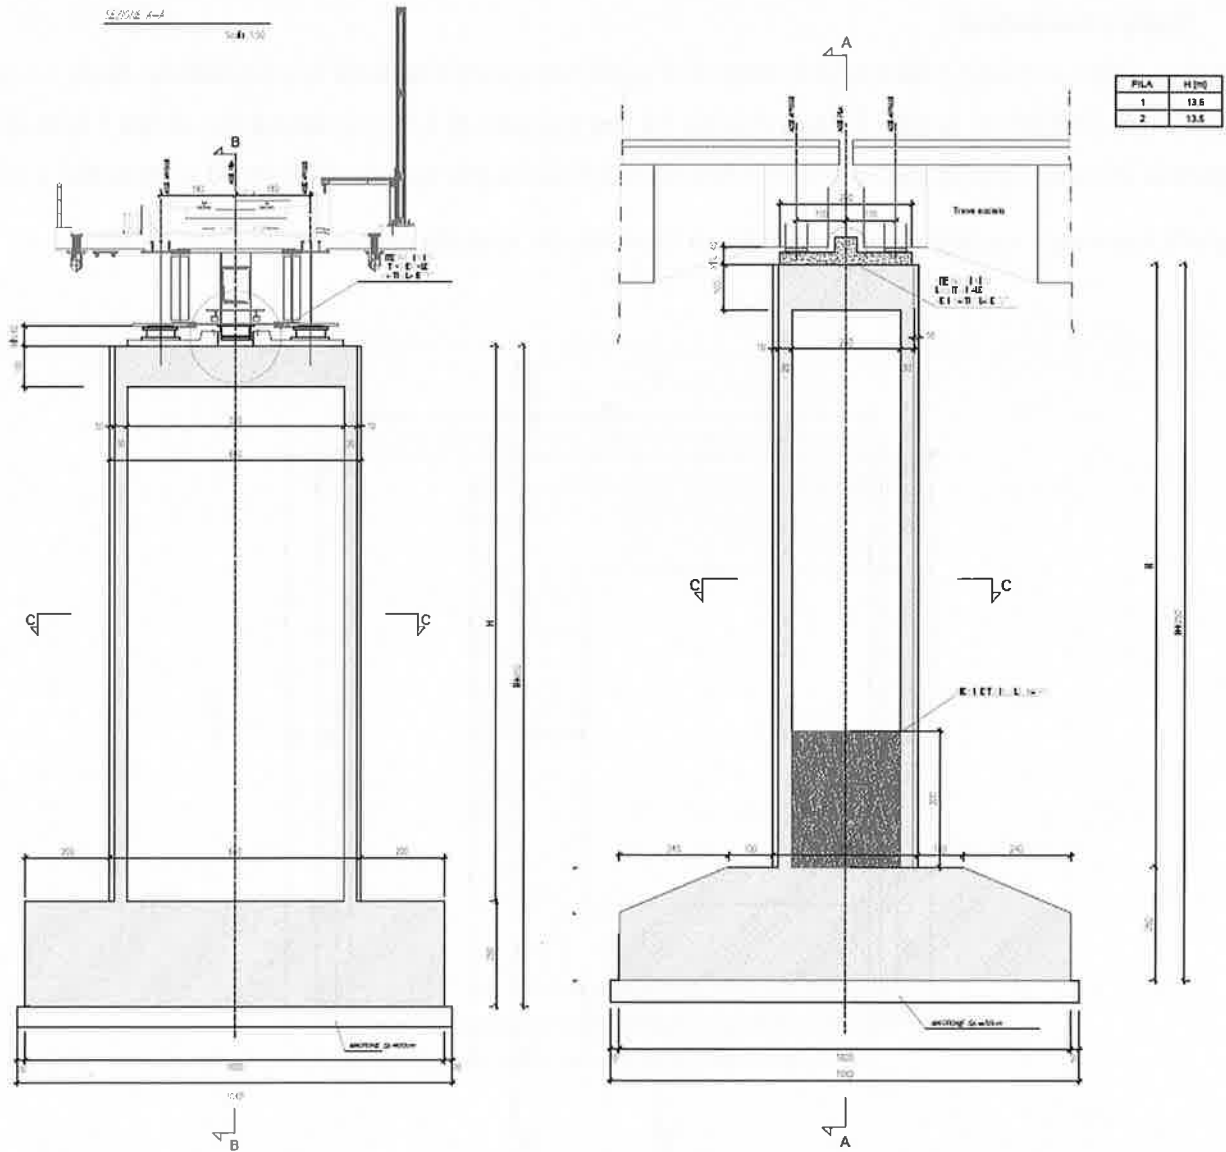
Sezione trasversale e longitudinale pile Bonorva VI02
